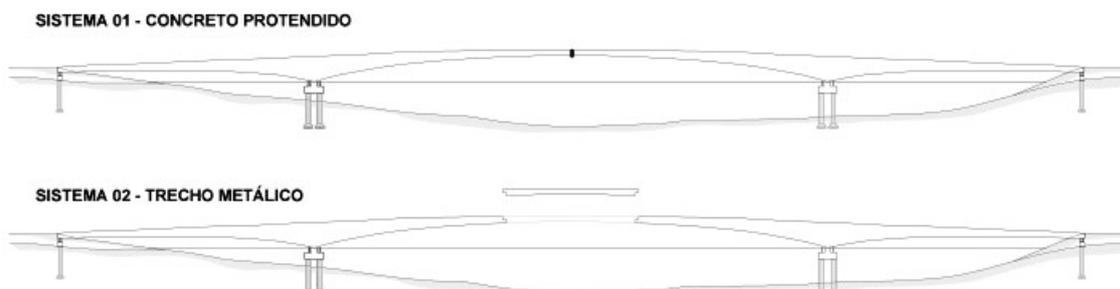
Projeto executivo original e projeto de reforço com em viga Gerber. Fonte: NOVACAP 1971.
